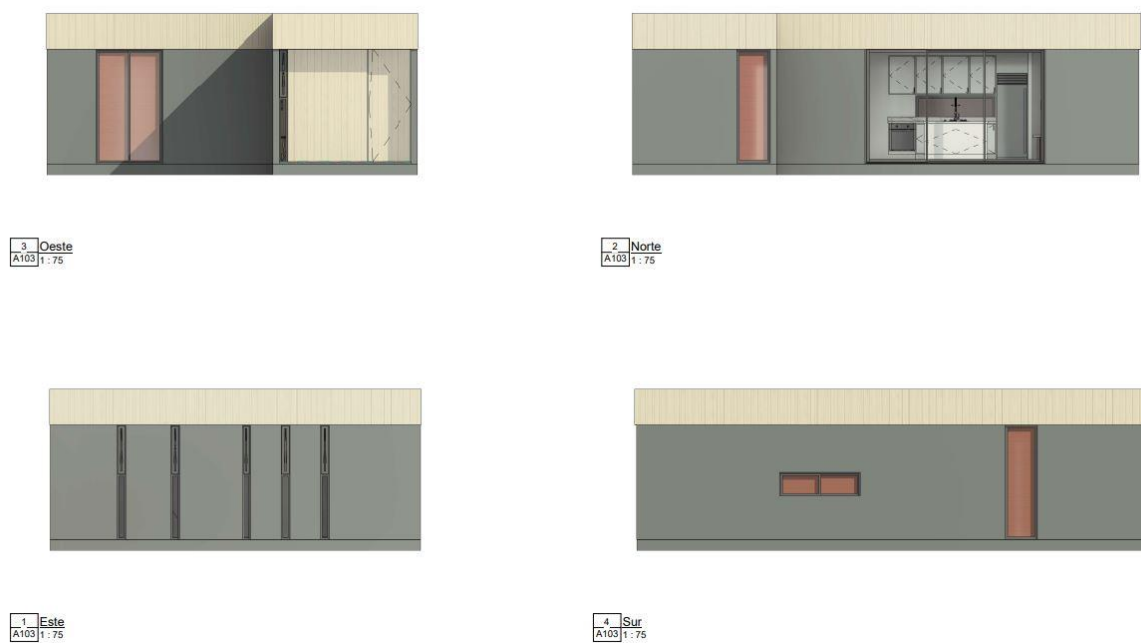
Alzados de Arquitectura Casa Cero.
